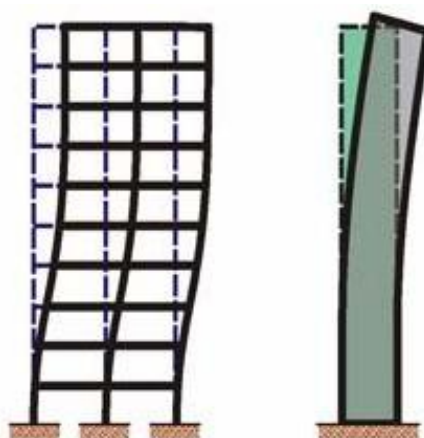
Deformada de um sistema porticado e de um sistema parede [5]
